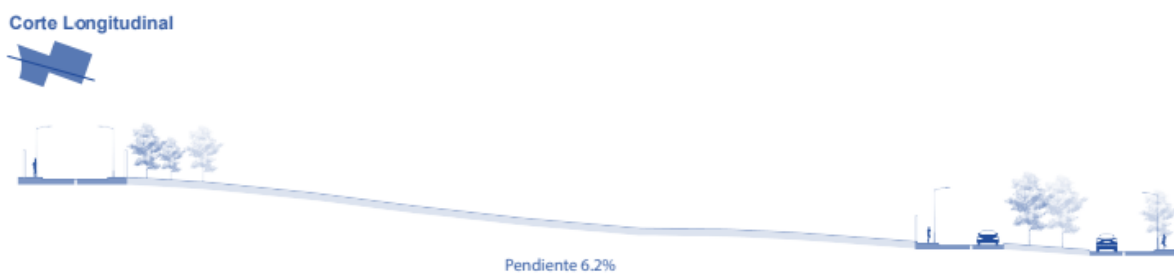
Corte longitudinal terreno. Elaborado por: Mateo Silva
